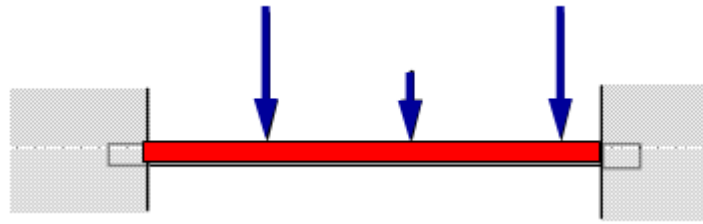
7 Illustration d'une poutre à double encastrement [4]
